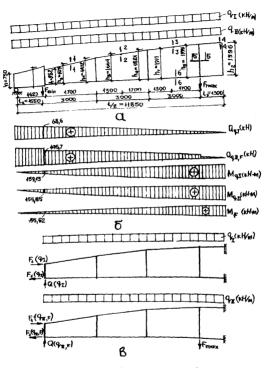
К расчету пнафрагмы панели-оболочки КСО 3х24м по деформациям досустная схема с использованием пластинчато-стержневой аппроксимации; о-эпоры ралочных усиляй; в-упроценный вариант расчетной схемы (стержневая аппроксимация)
